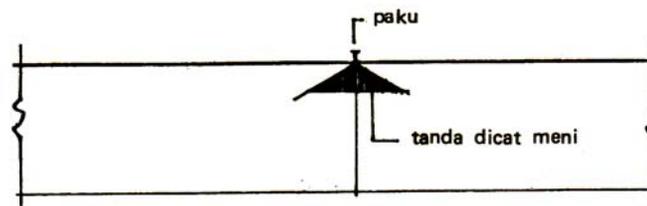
, Pemasangan Bouwplank di Sekeliling Bangunan
